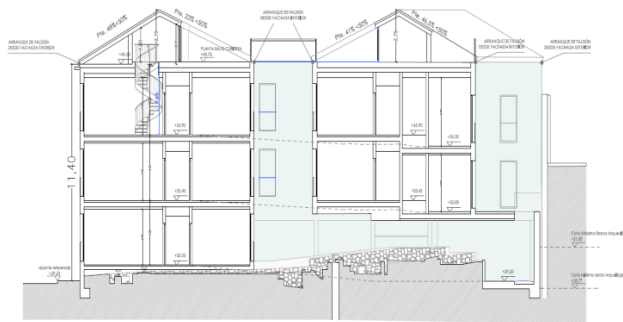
Esquema de la sección propuesta incluida en el Plano ED-07.
